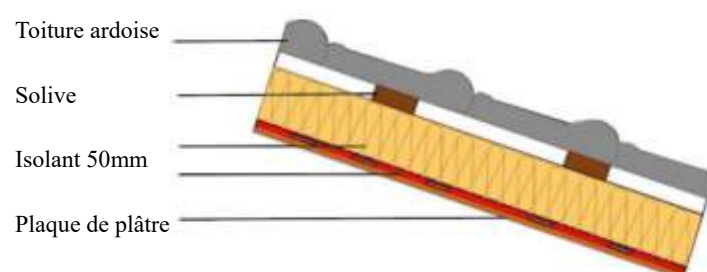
Les couches d'une toiture / source : la structure en bois traité par l'auteur
